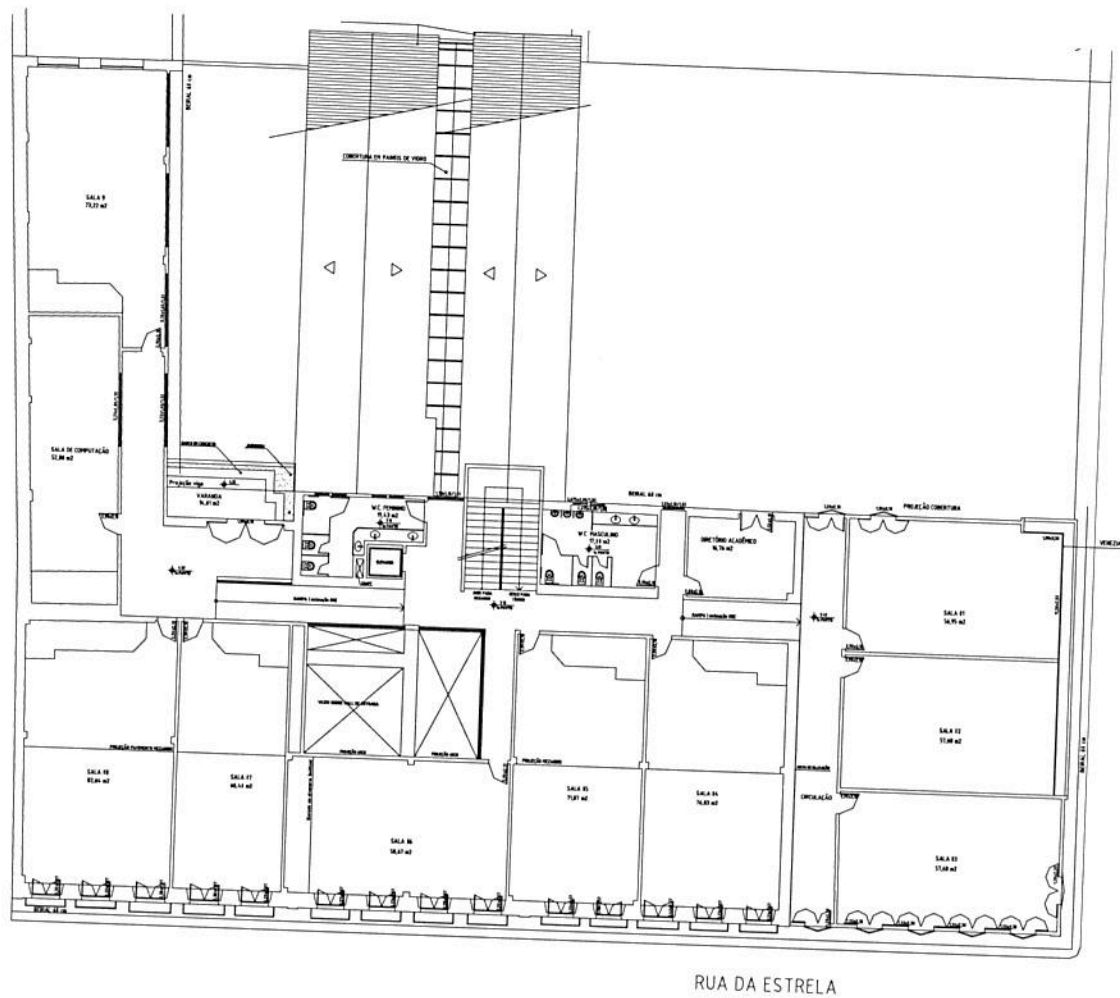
Planta Baixa - 1º Pavimento (Sem Escala)
